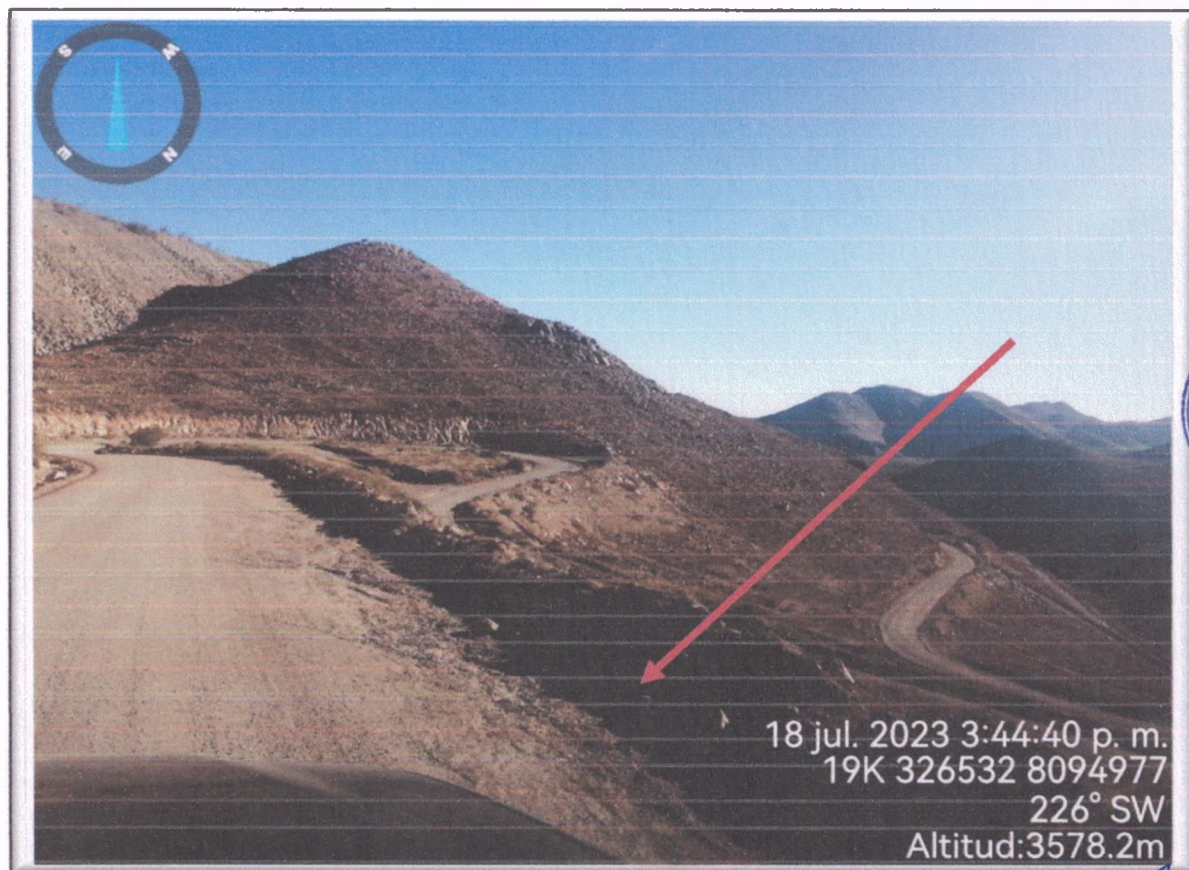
Vista de Cuneta saturada de piedras, arena y tierra en MD.
